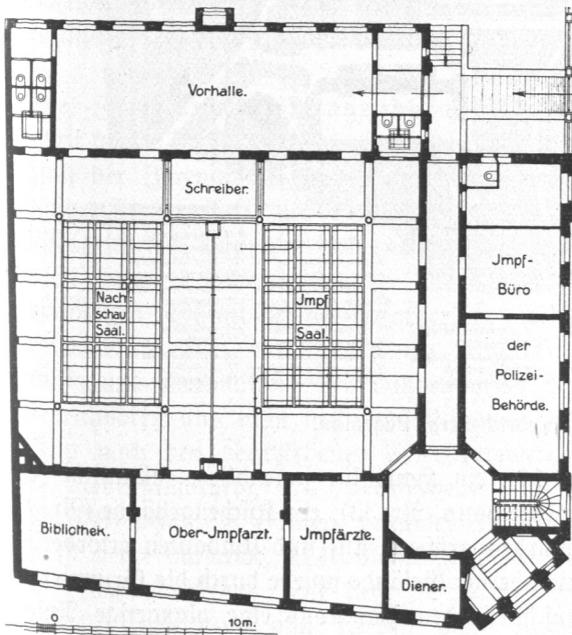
Staatsimpfanstalt, Erdgeschoß, Grundriß.
